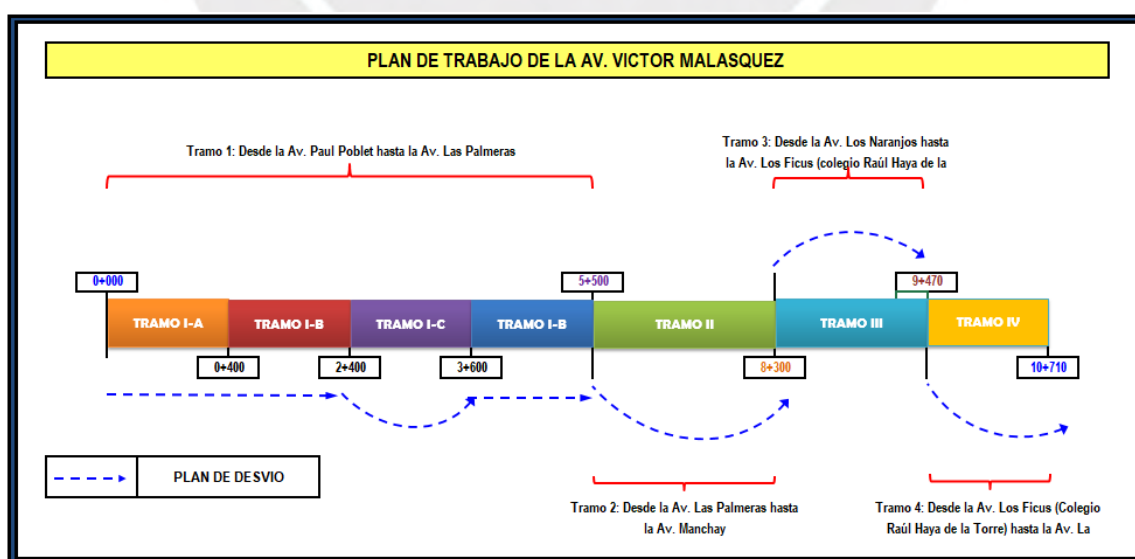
Plano simplificado del proyecto, sectorización según plan de desvío de Av. Víctor Malásquez. Adaptado Propio
